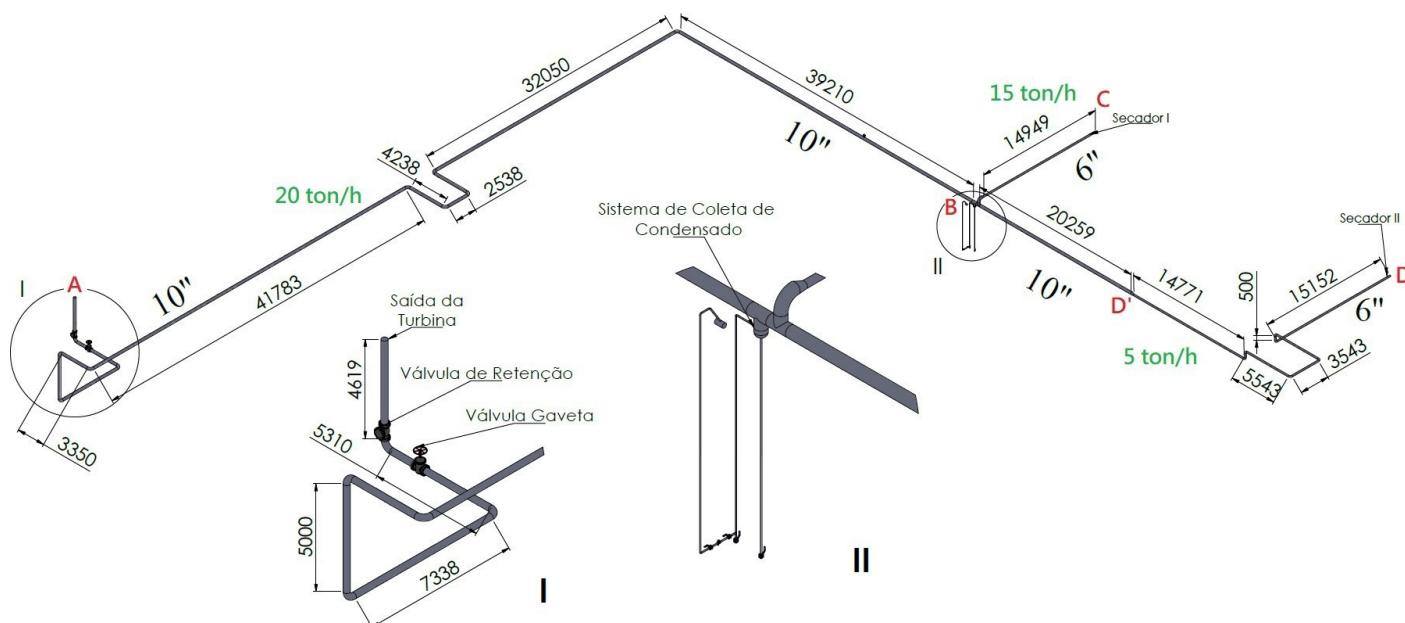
Layout atual da rede de vapor (dimensões em mm).
